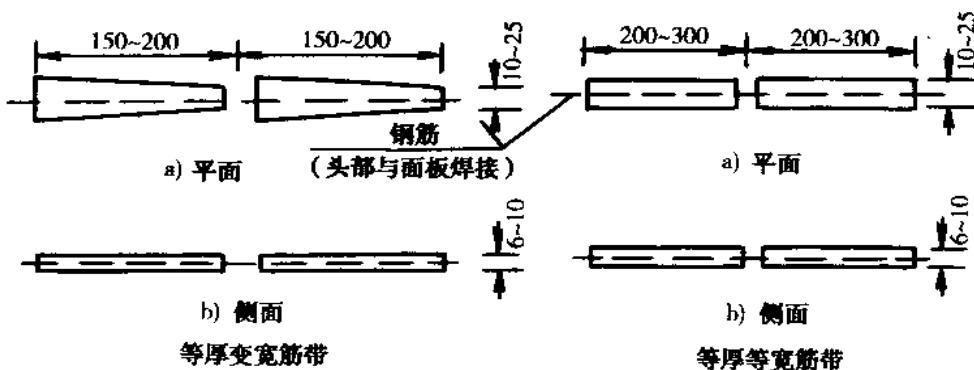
钢筋混凝土拉筋 尺寸单位:cm
